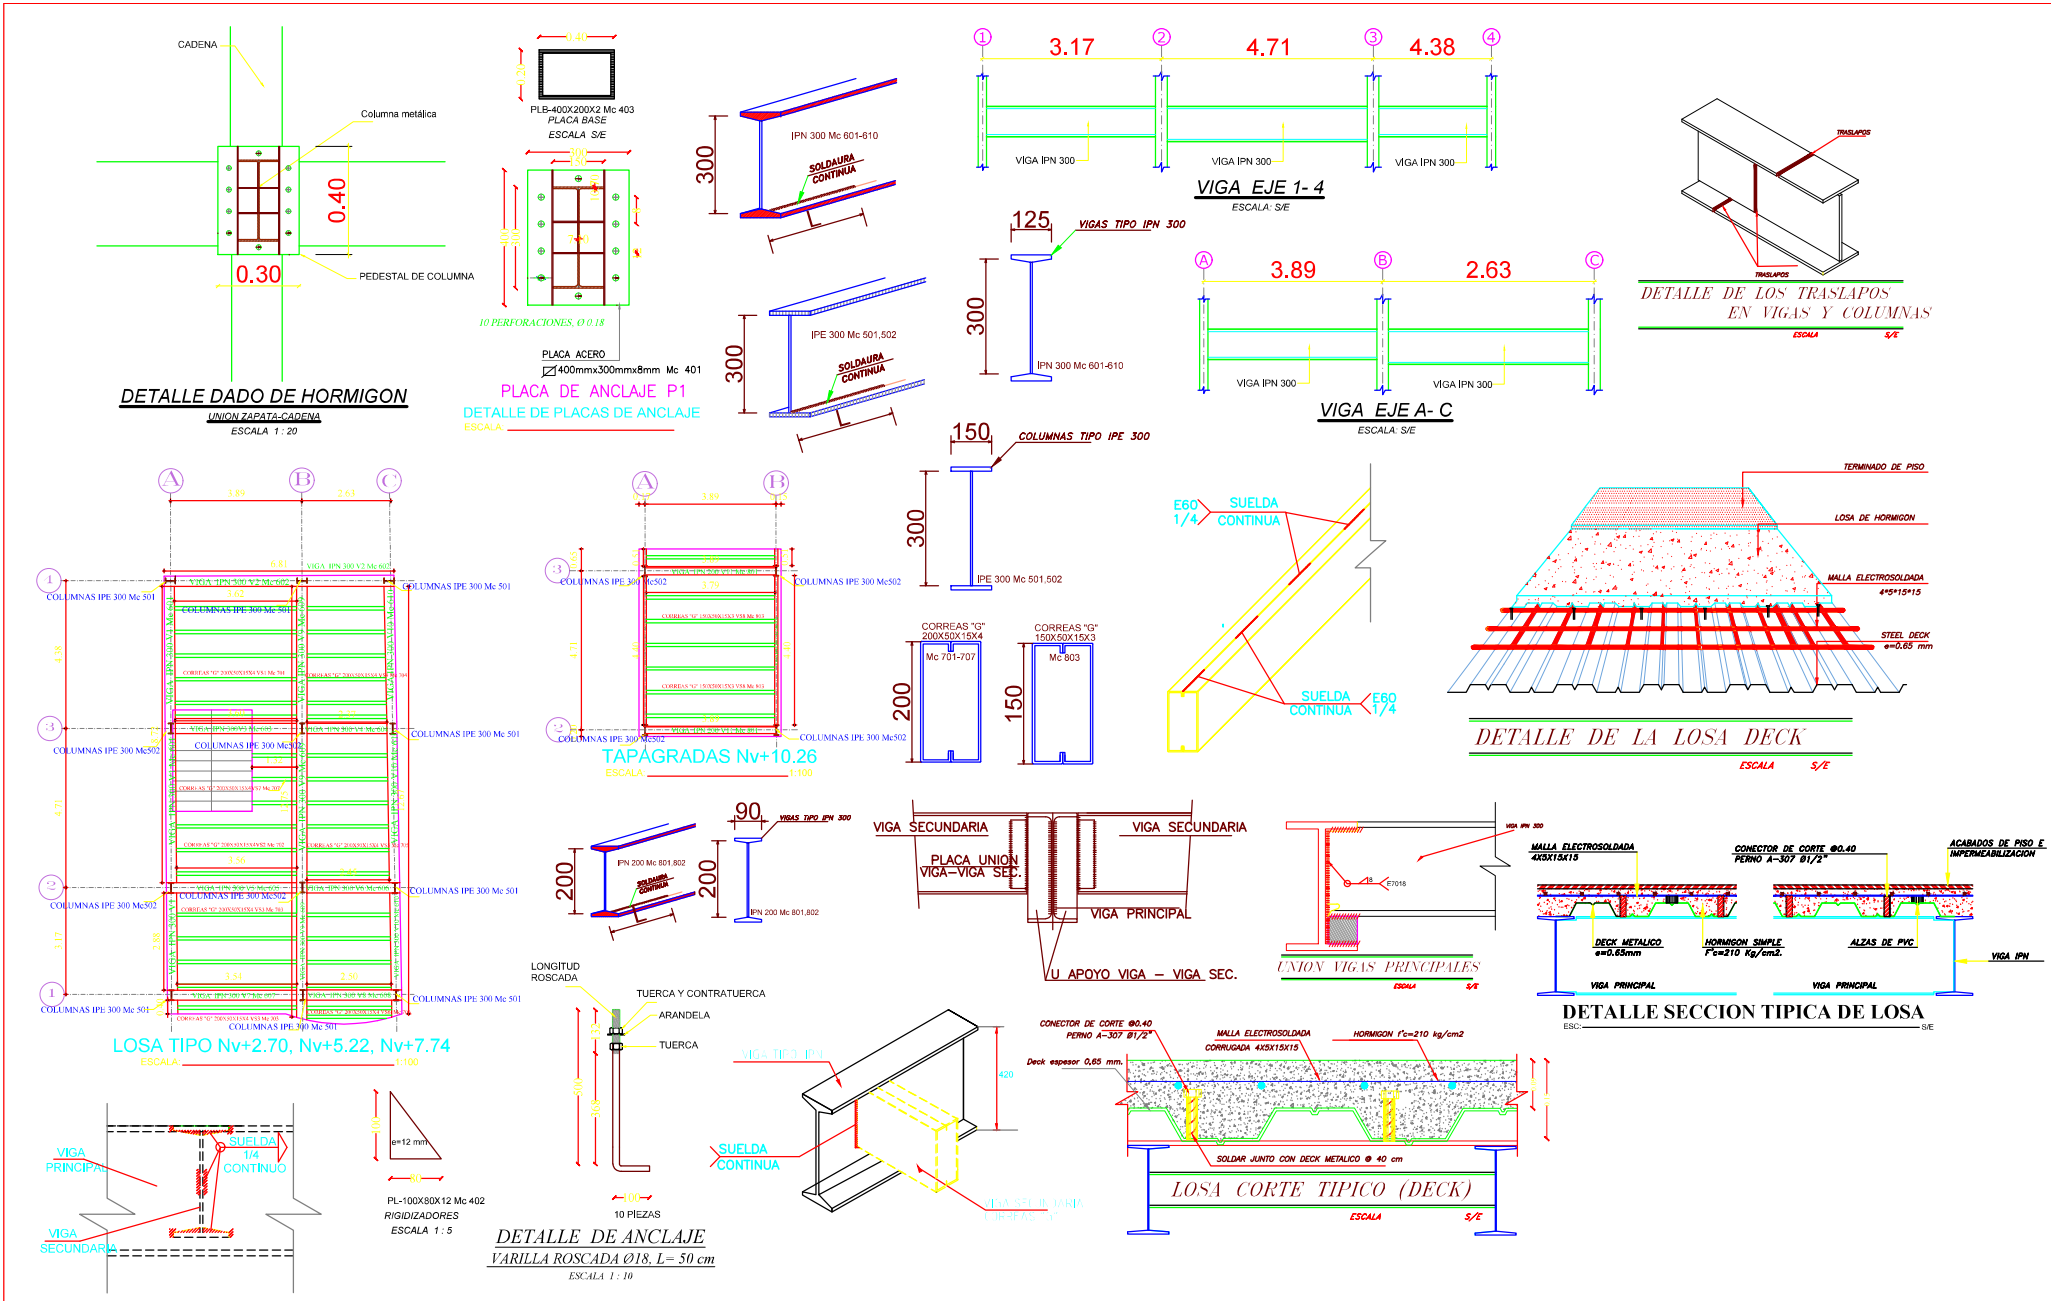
Elementos estructurales y detalles constructivos del sistema de estructura de acero.
